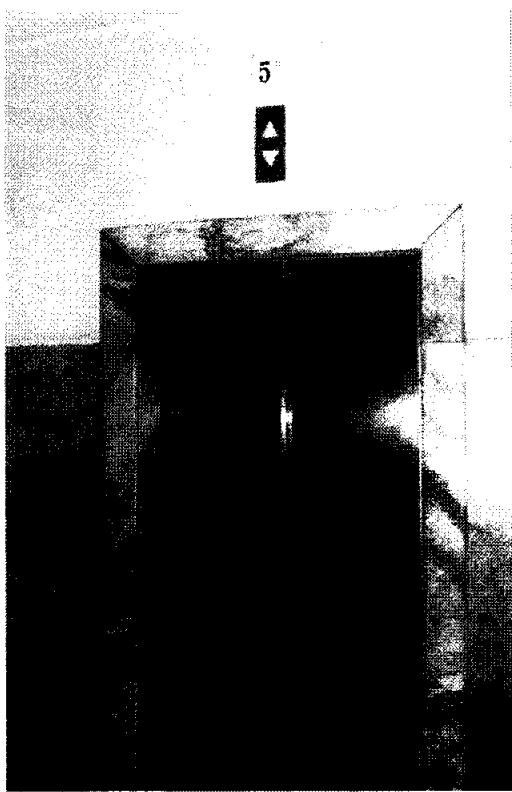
Foto do Hall do Elevador no 5º Pavimento
